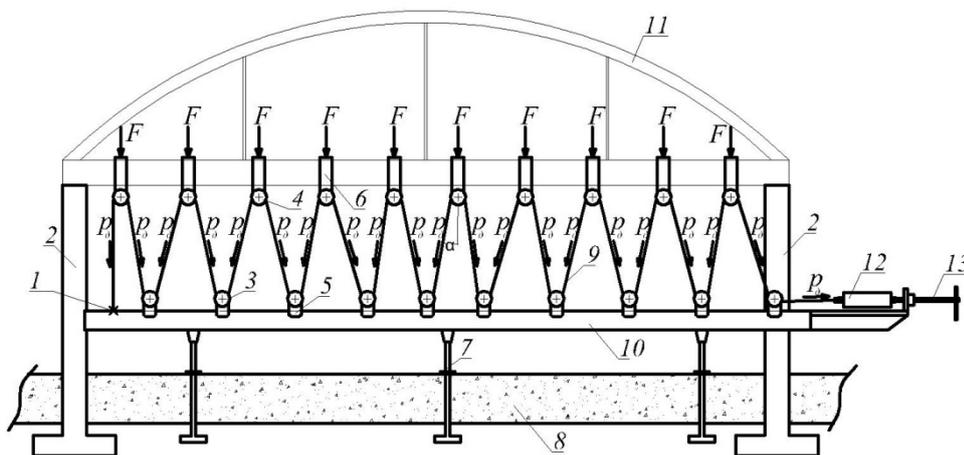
Схема работы стенда для испытания арочной конструкции: 1 – крепежное кольцо; 2 – опоры; 3, 4 – шкивы; 5, 6 – хомуты; 7 – анкерные болты; 8 – силовой пол; 9 – трос; 10 – вспомогательная балка; 11 – арочная конструкция; 12 – динамометр; 13 – винтовое устройство
